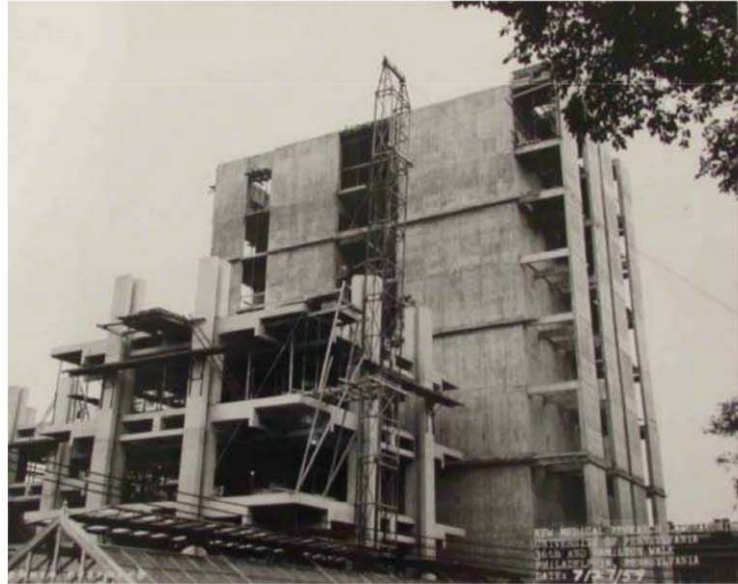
Fotografía que muestra los dos sistemas constructivos, las piezas prefabricadas y el hormigón in situ de la torre "X". No. de archivo: 030. IV.A.490.12.51.The A.A., U. of Penn.
